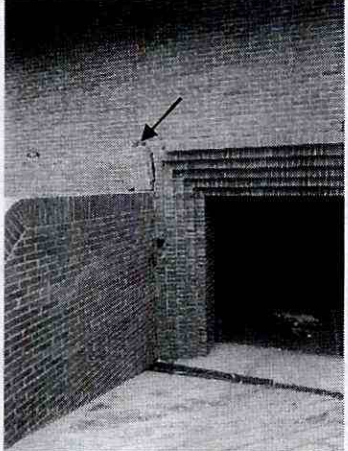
Sótano – Pared localizada bajo la sala de estar interior del apartamento 102. Se observan la tendencia escalonada de pared de las fisuras reportadas
